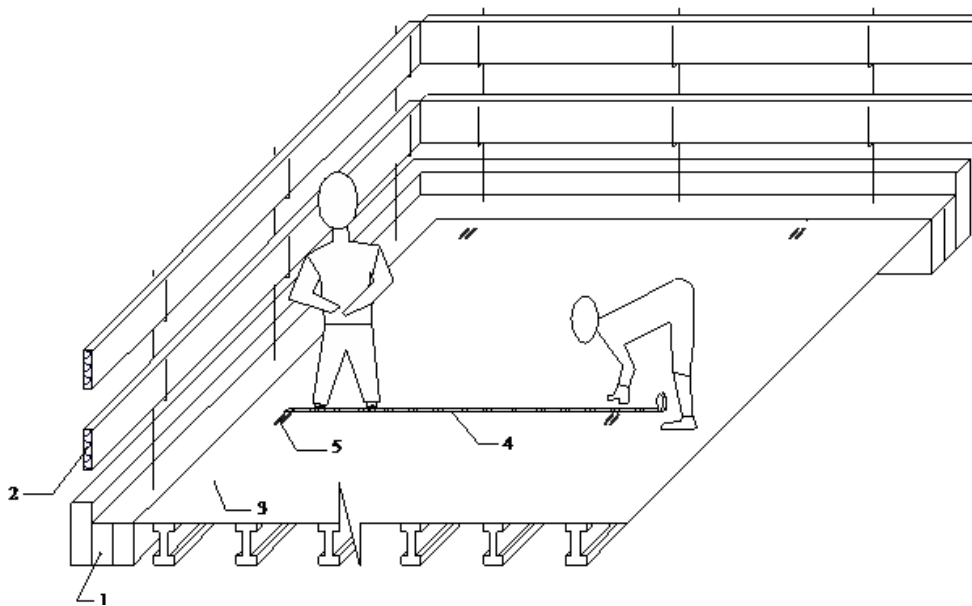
Розбивка опалубки при влаштуванні нижньої арматурної сітки:
